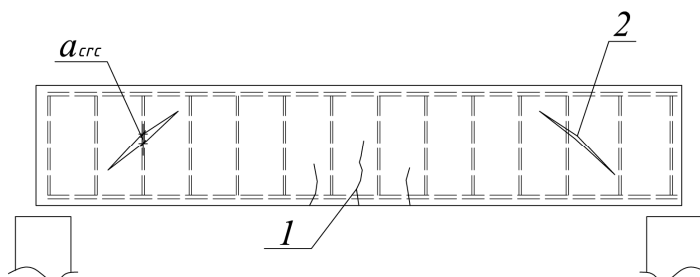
Железобетонный элемент с трещинами при изгибе: нормальные (1), наклонные (2) трещины.
